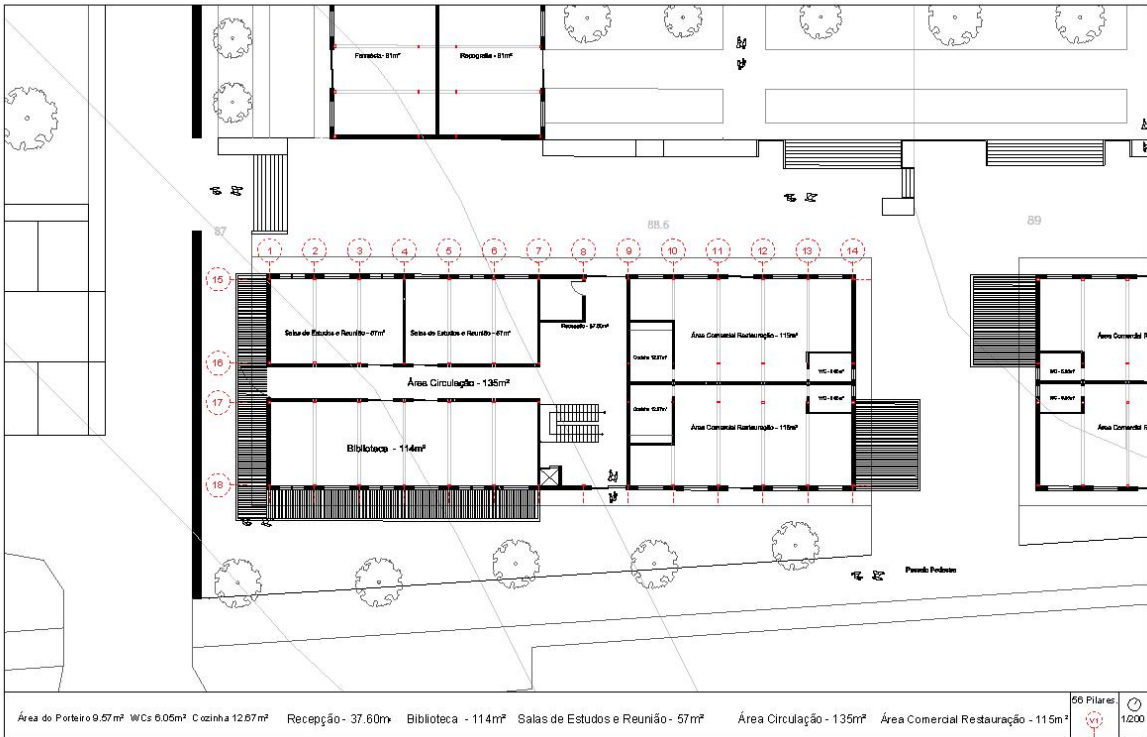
Planta do Térreo 1 Bloco 1/200.
